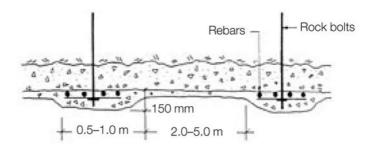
Крепление арками и набрызабетоном, армированным фибрами
